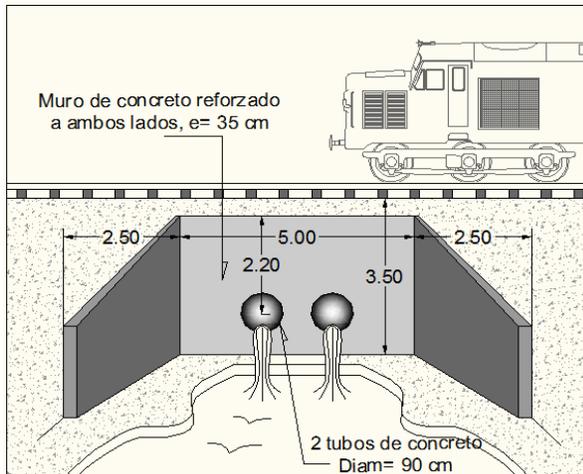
Detalle de obra complementaria #26, (Fuente: Autor)
